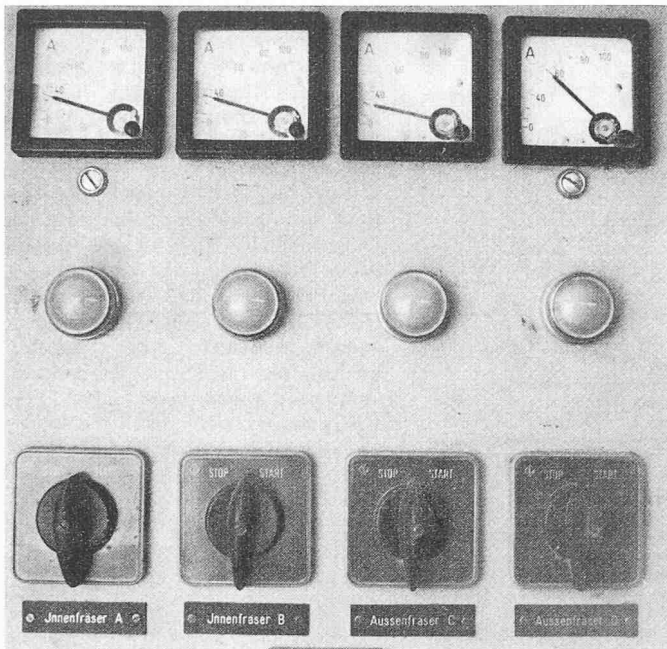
Momentaufnahme der Ampèremeter der vier Fräsermotoren. Zulässige Dauerbelastung der Innenfräser 40 A, der Aussenfräser 52 A
